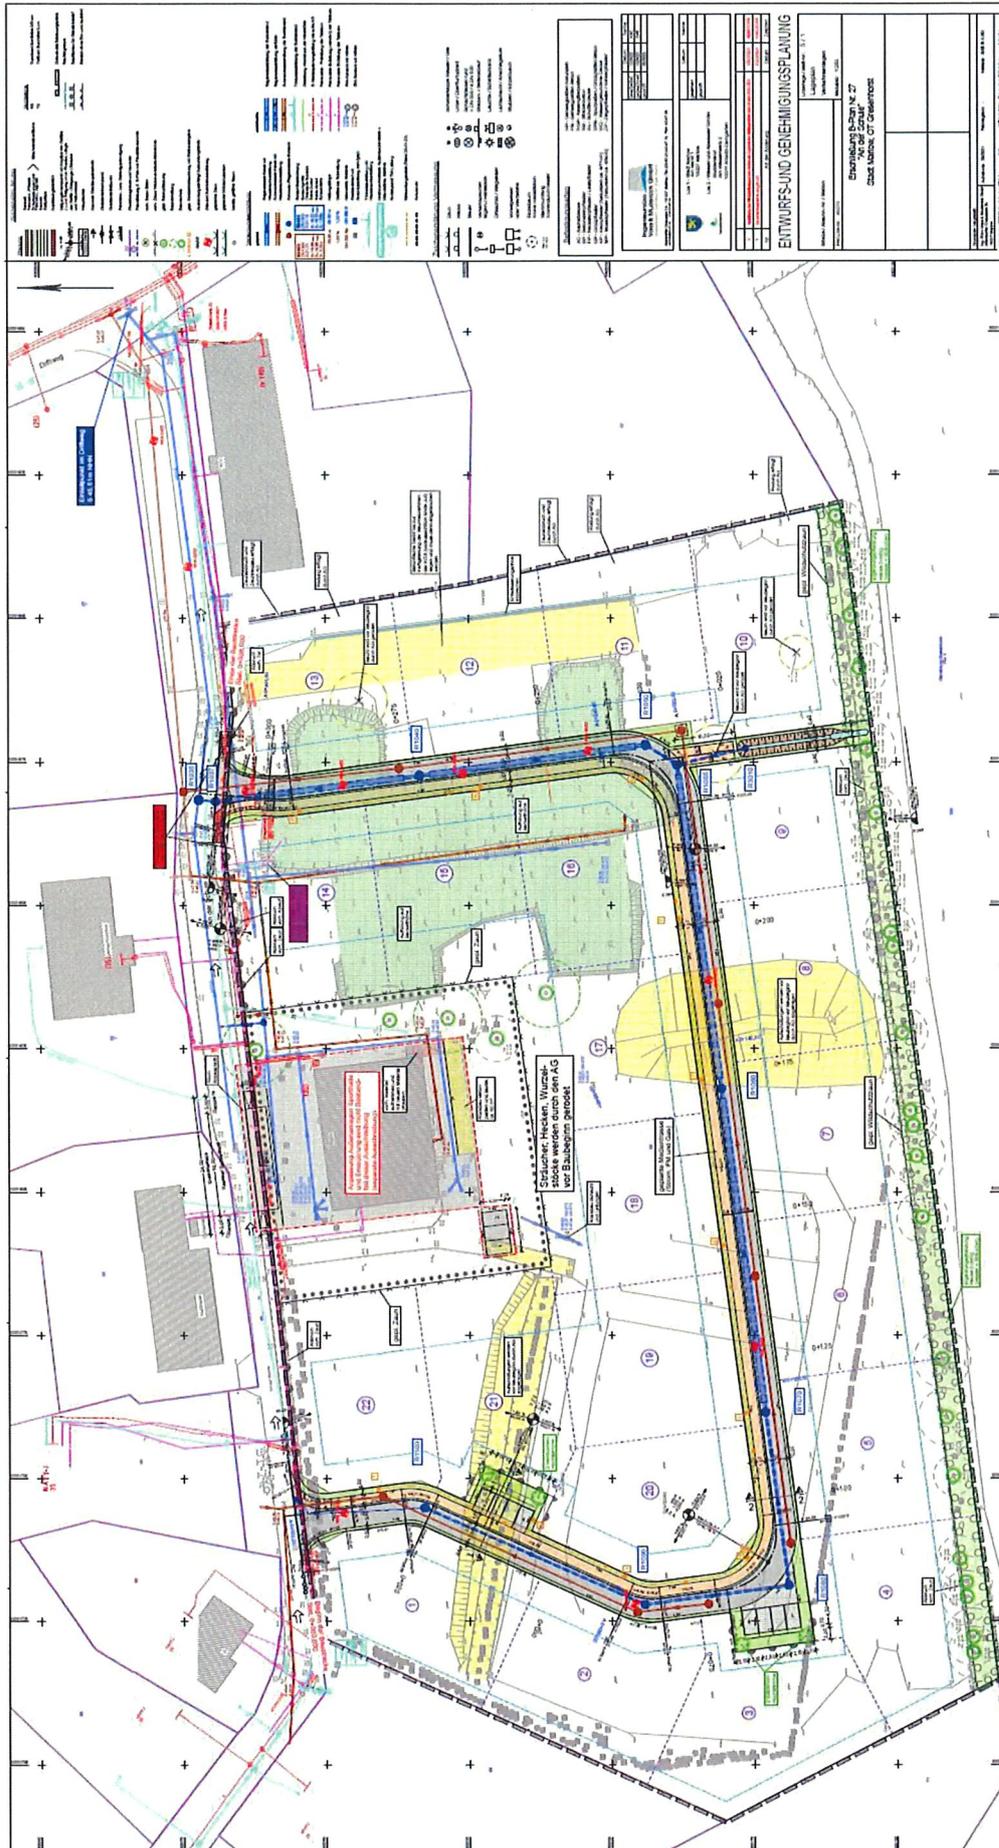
Erschließung B-Plan Nr. 27 "An der Schule" Stadt Marlow, OT Gresenhorst. Quelle: ENTWURFS- UND GENEHMIGUNGSPLANUNG Lageplan Verkehrsanlagen, VOSS & MUDERACK 10.05.2023.
